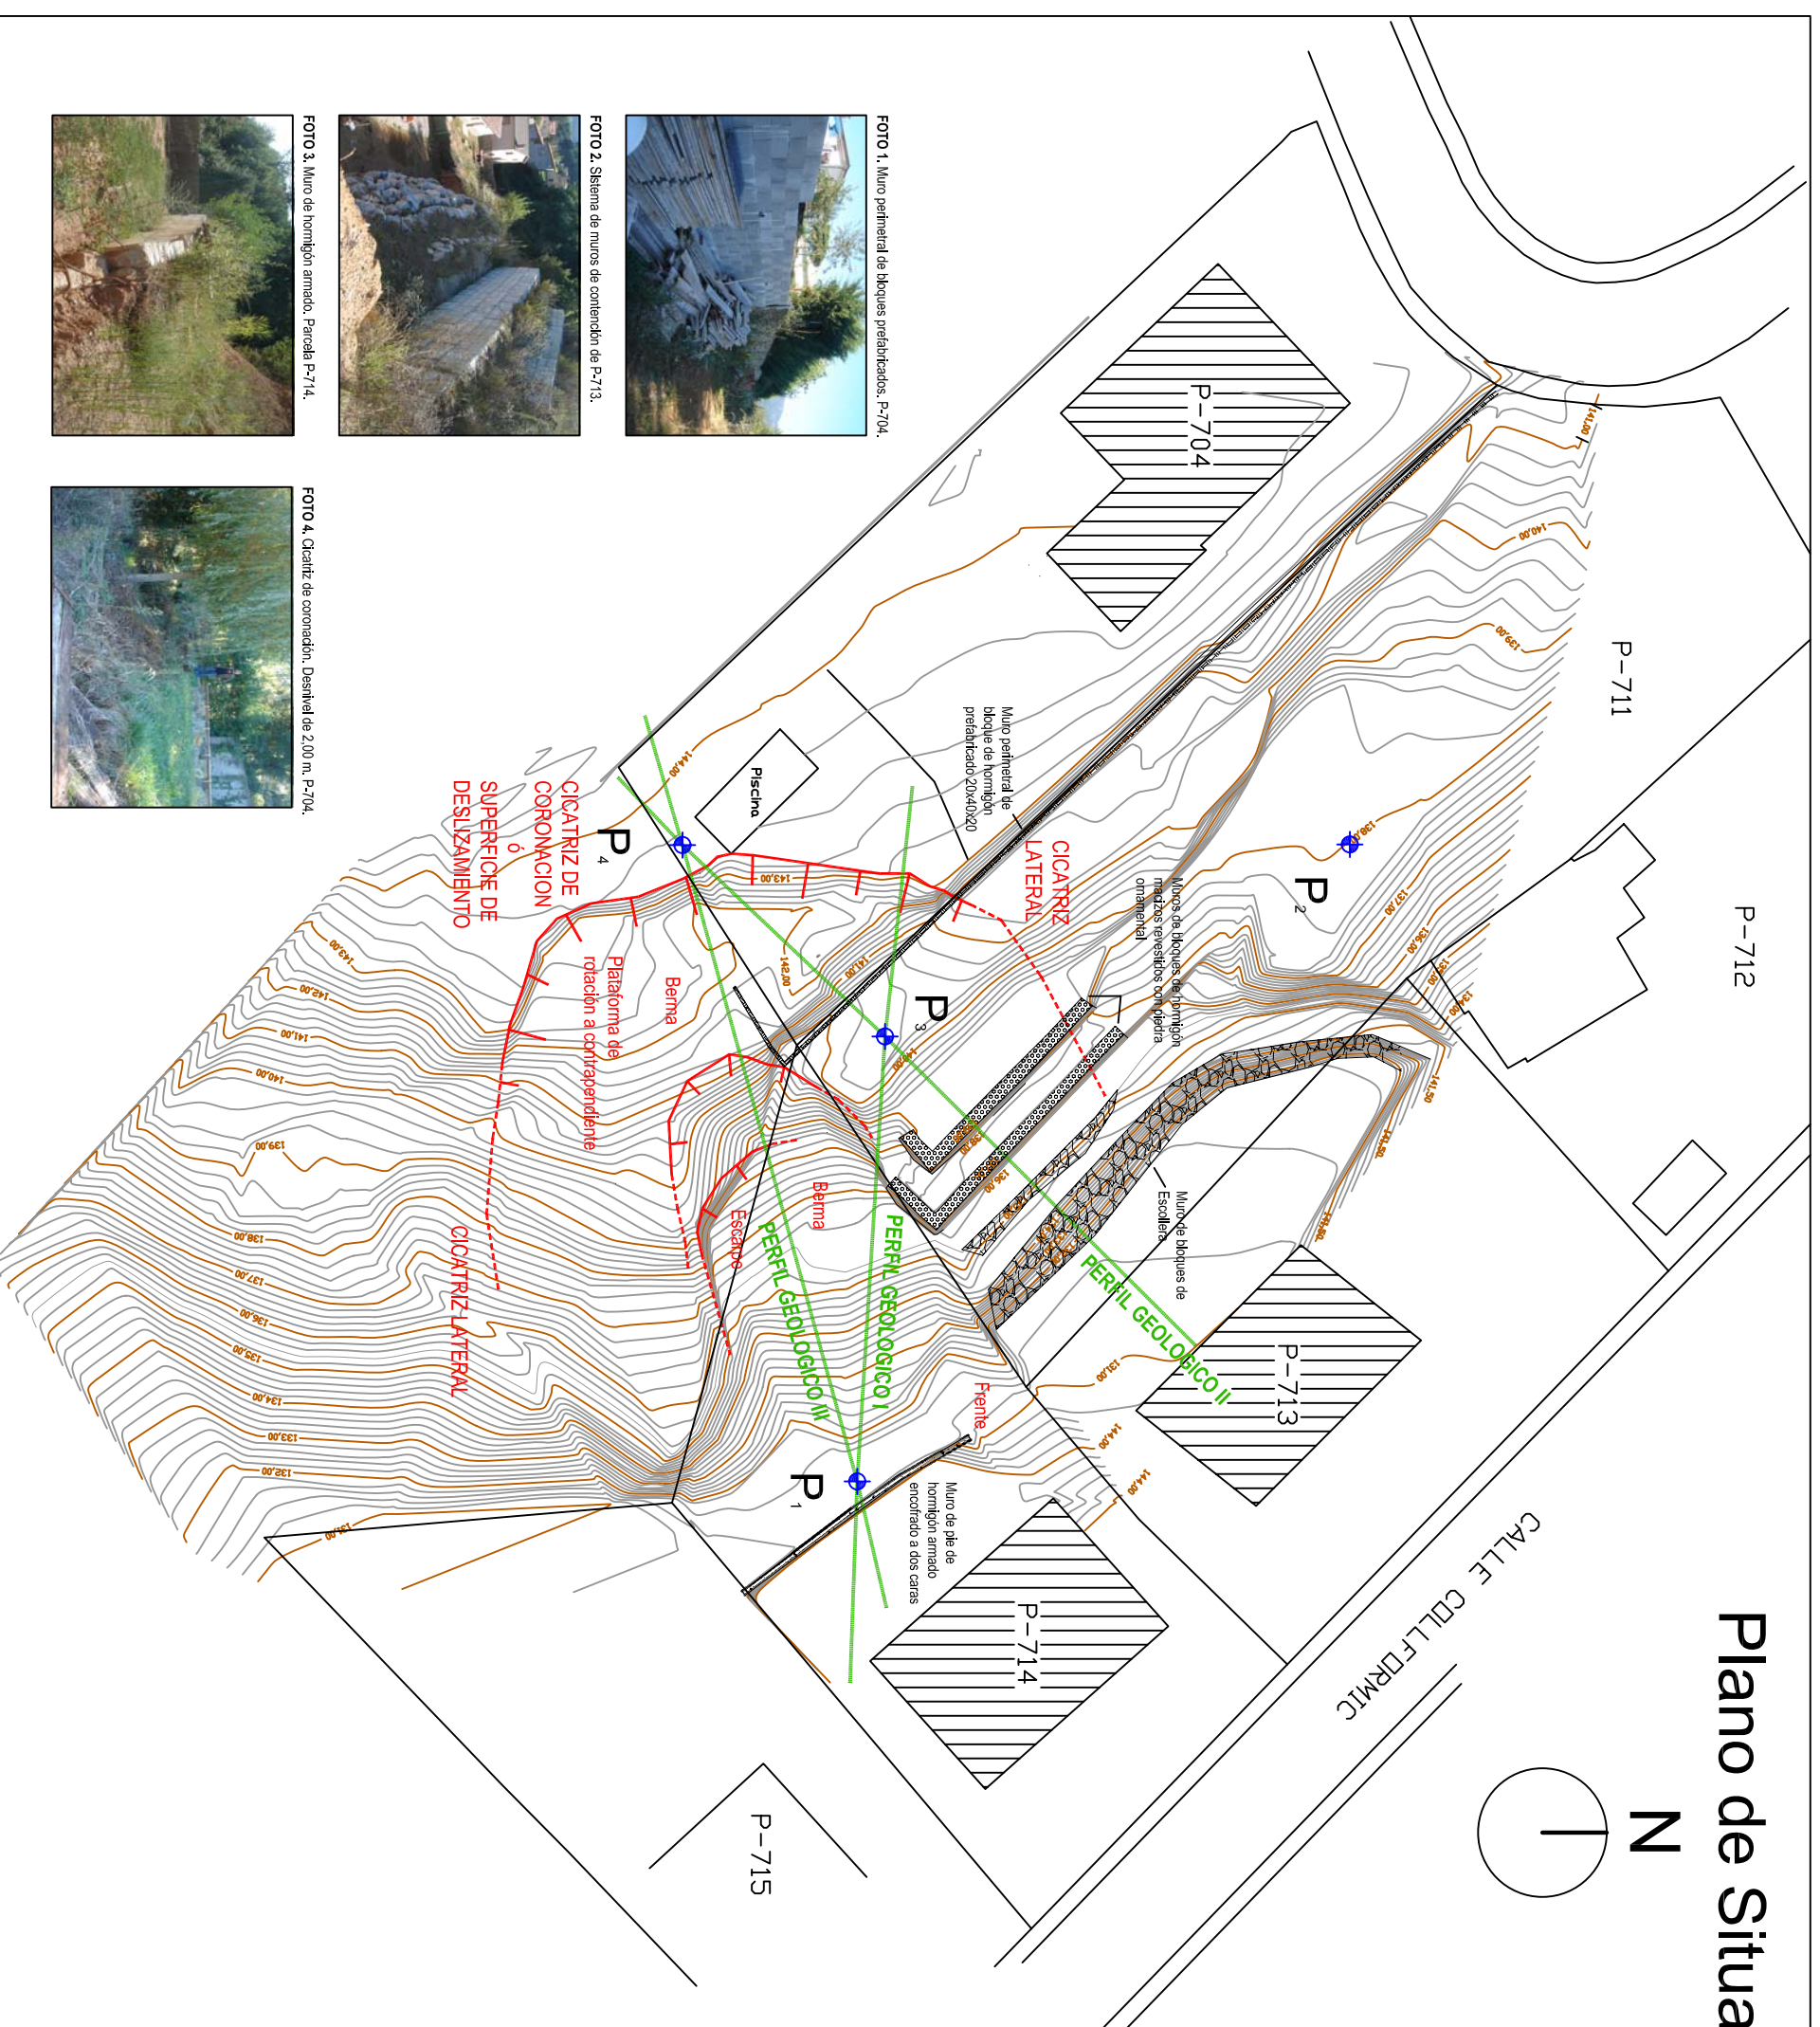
Muro perimetral de bloques prefabricados. P-704.
